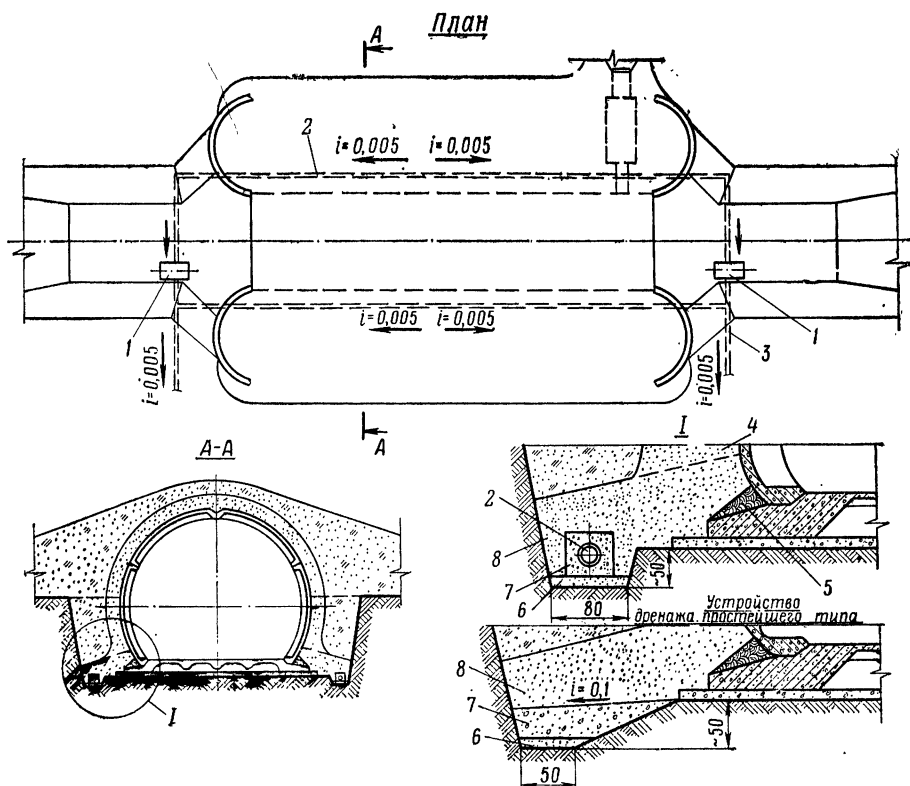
Устройство дренажа при возведении сооружений из железобетонных элементов:
